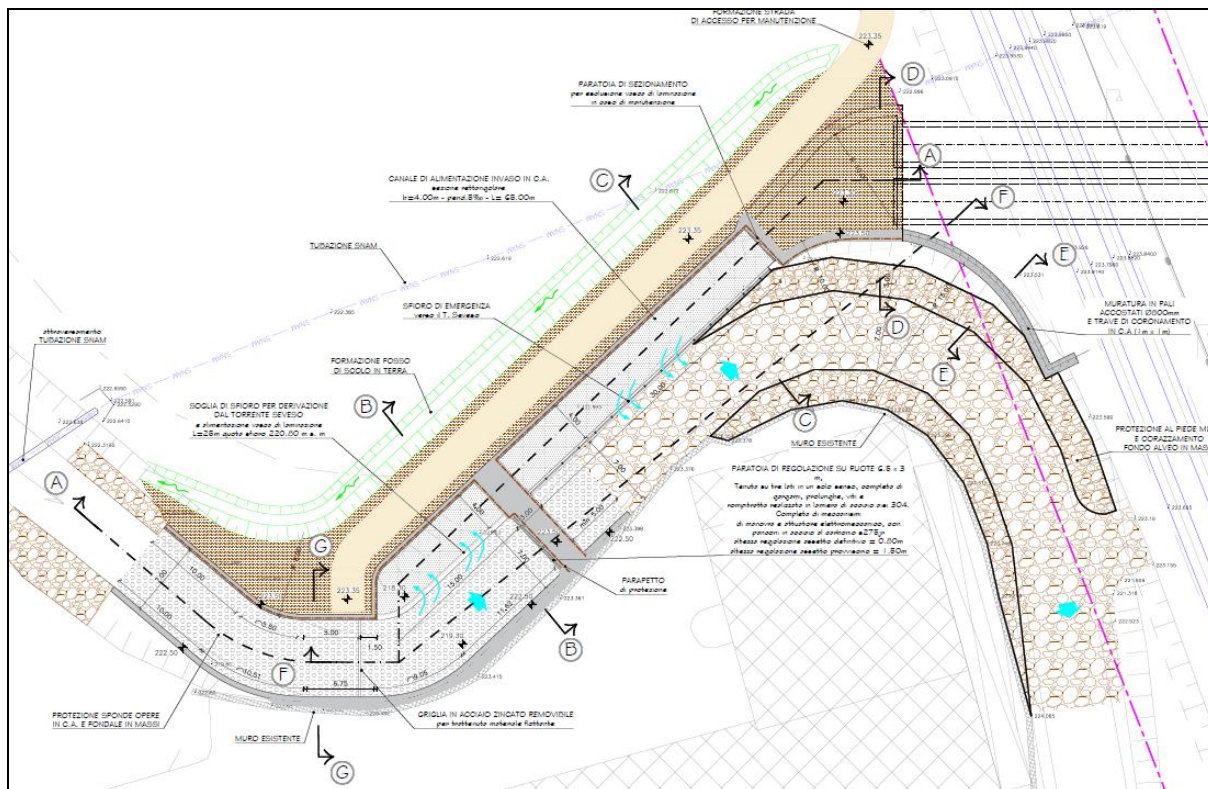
Planimetria di progetto dell'opera di presa dal T. Seveso
